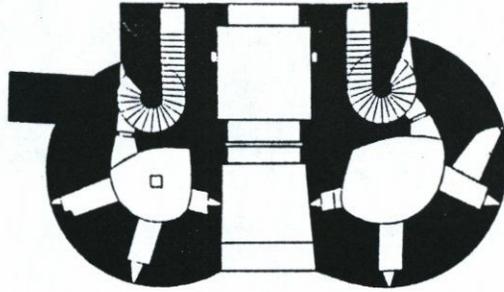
Aachen, Marschierotor. Grundriß des Erdgeschosses.
